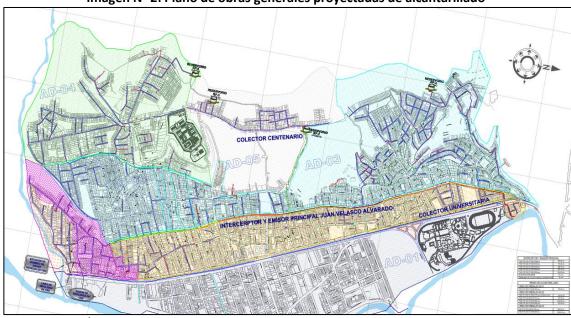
Plano de obras generales proyectadas de alcantarillado
